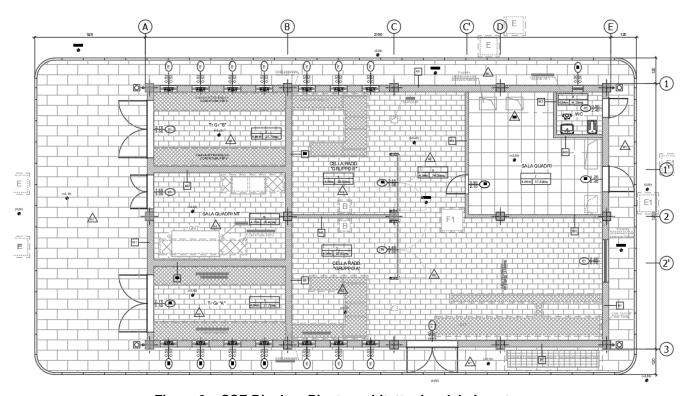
SSE Ripalta - Pianta architettonica del piano terra
